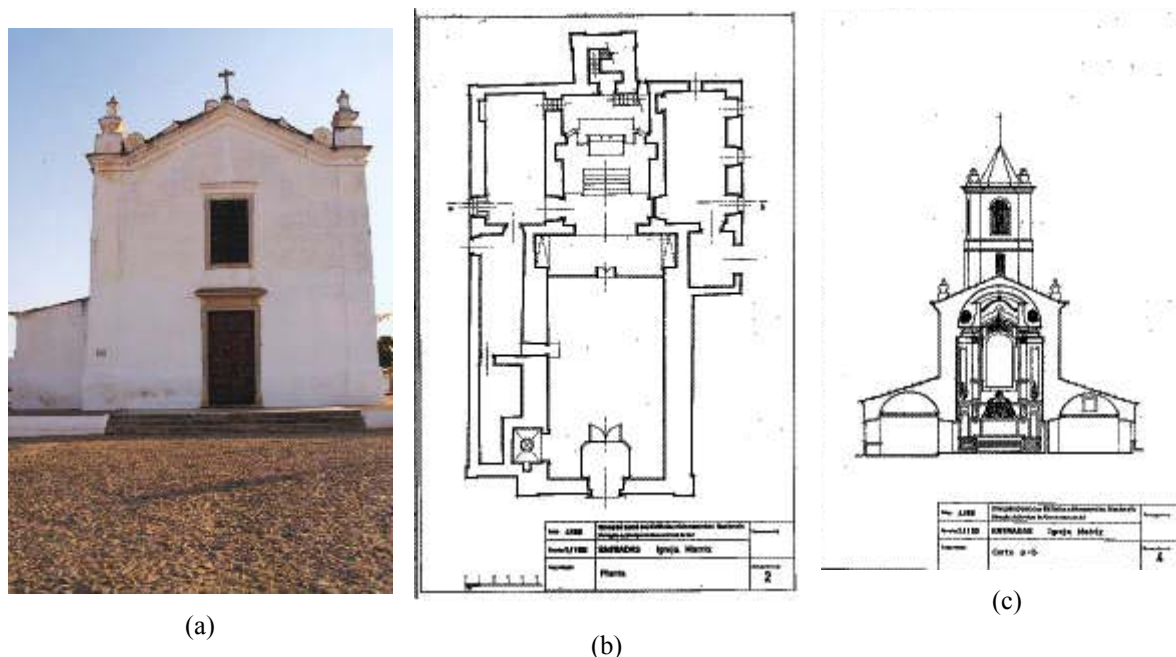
Peças desenhadas [DGEMN]: (a) fotografia da fachada; (b) planta; (c) corte transversal.
